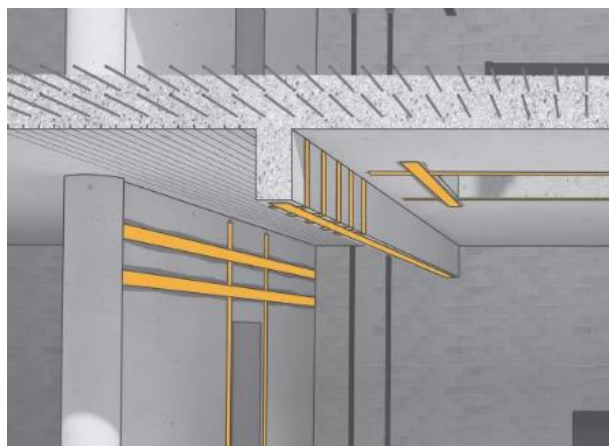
Renforcer les structures béton avec des textiles. [26]
